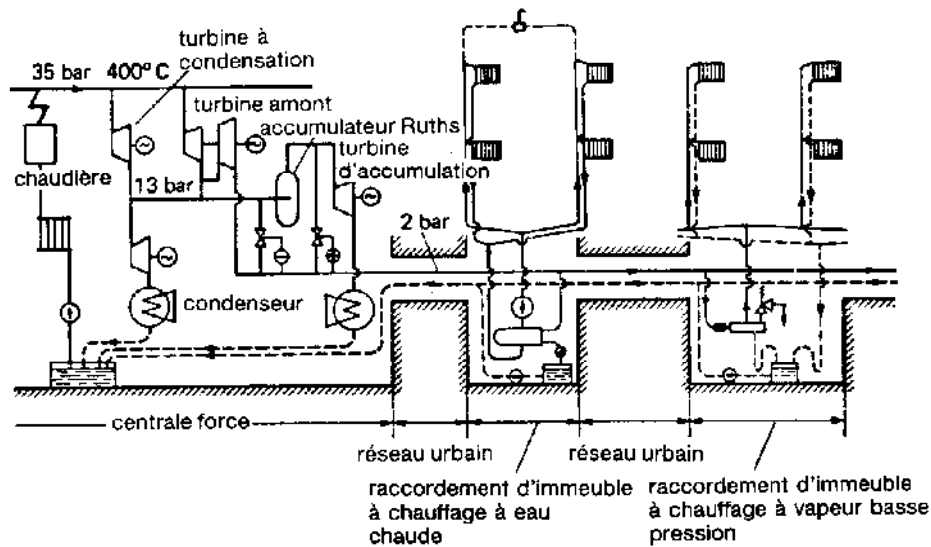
Schéma de principe d'un chauffage à vapeur par centrale chaleur-force desservant des constructions alimentées en chauffage soit à eau chaude soit à vapeur basse pression.
